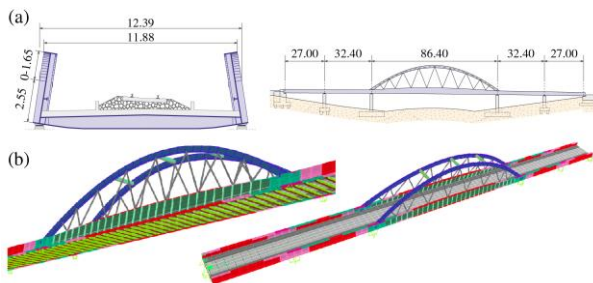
Sección transversal y vista lateral (a), y MEF del viaducto de Santa Ana (b) (Unidades en m).
